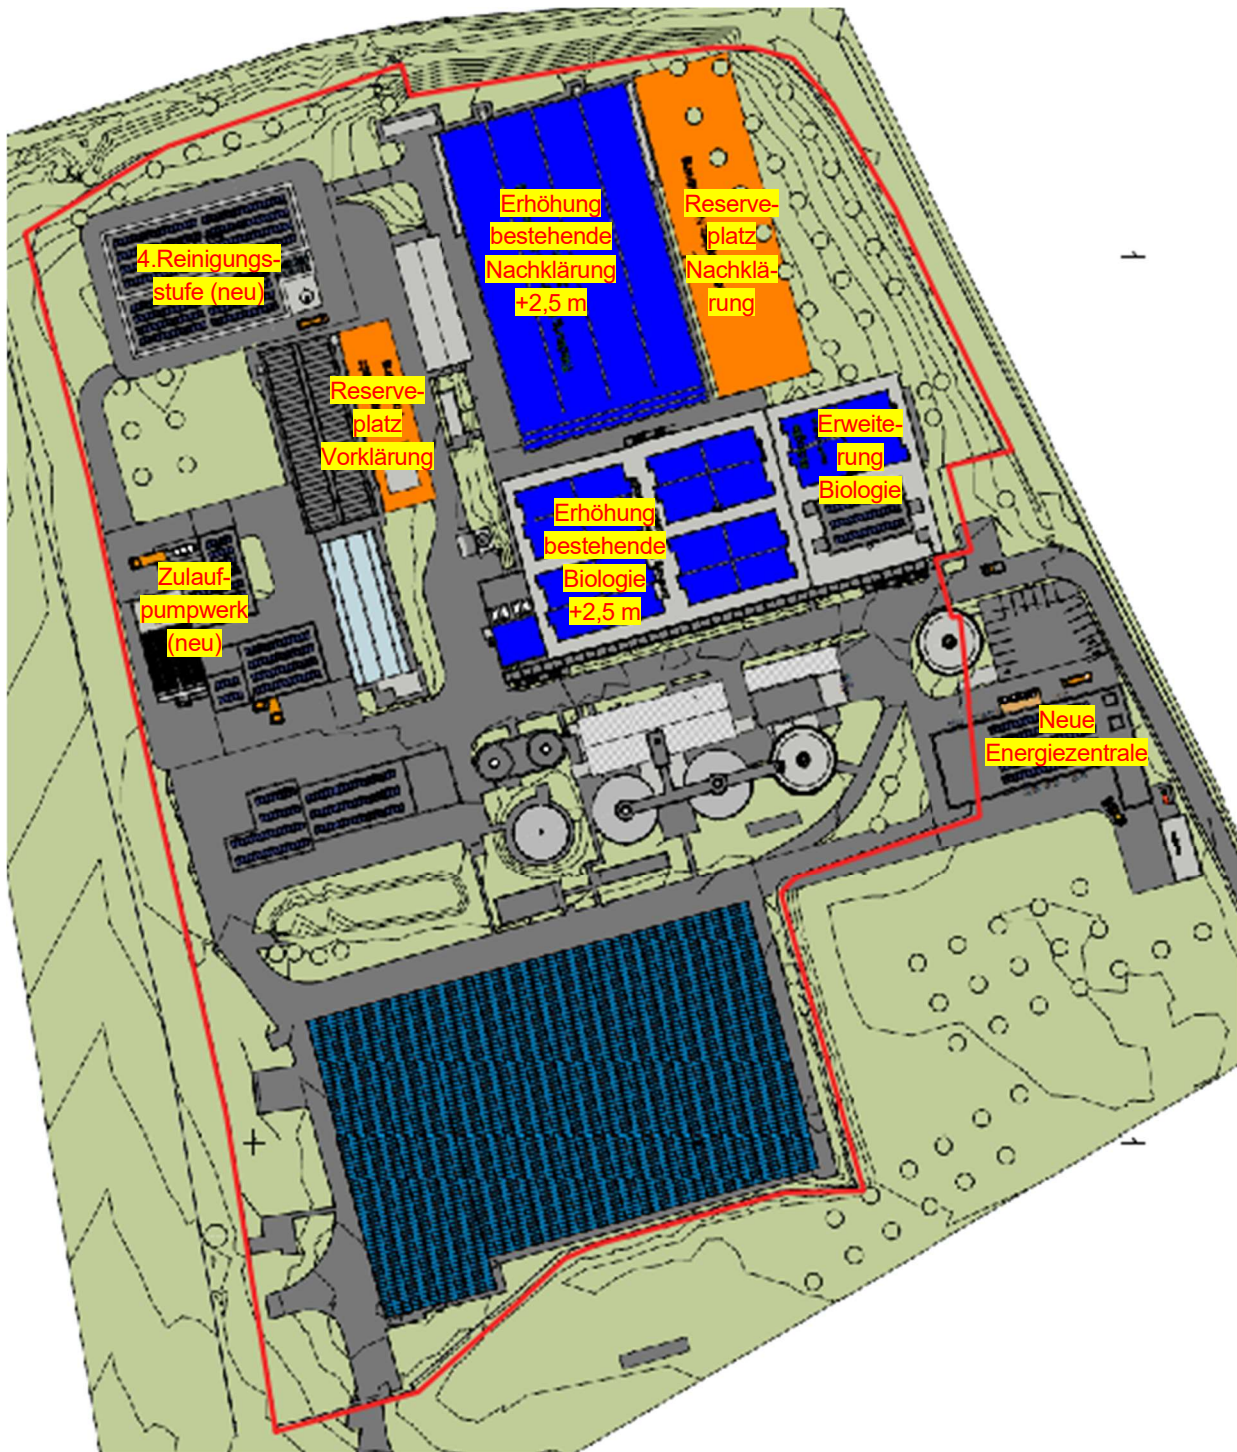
Situationsplan der Kläranlage Bettembourg nach erfolgtem Ausbau mit den wesentlichen Änderungen (bestehende Umzäunung in rot)
